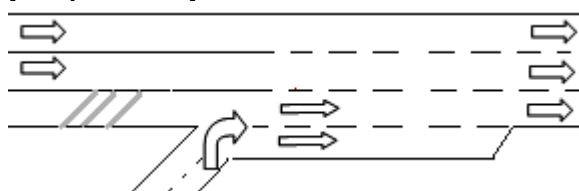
MÚK Exit Roztyly – snímek [Zdroj autor DP]
